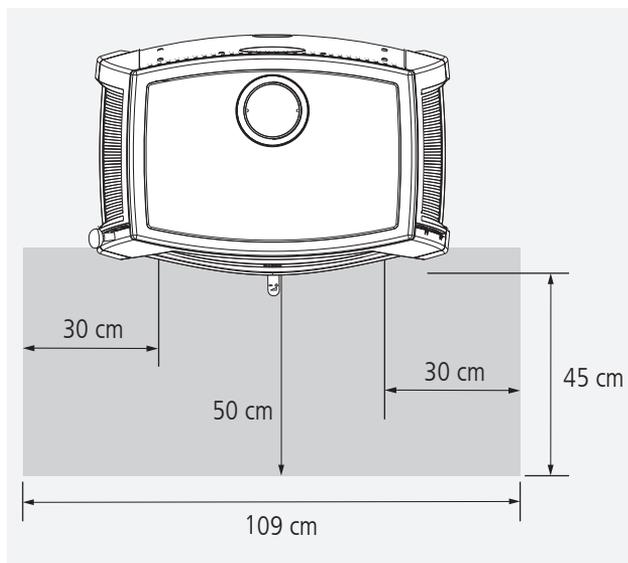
Revêtement incombustible devant la porte de la chambre de combustion de l'APELLA
